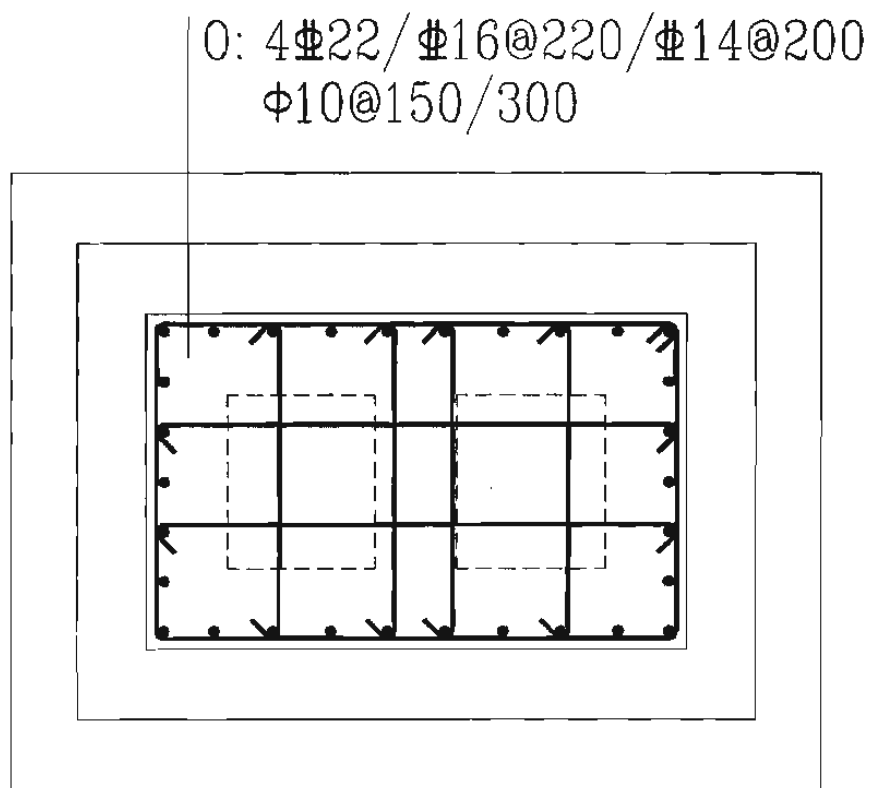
双高杯口独立基础杯壁配筋示意
